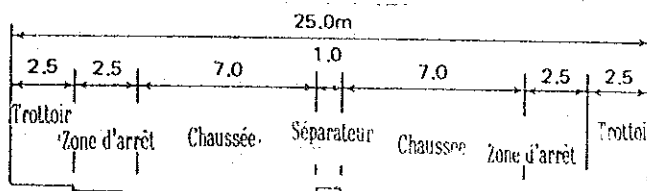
(2) Coupe transversale standard d'une route principale
